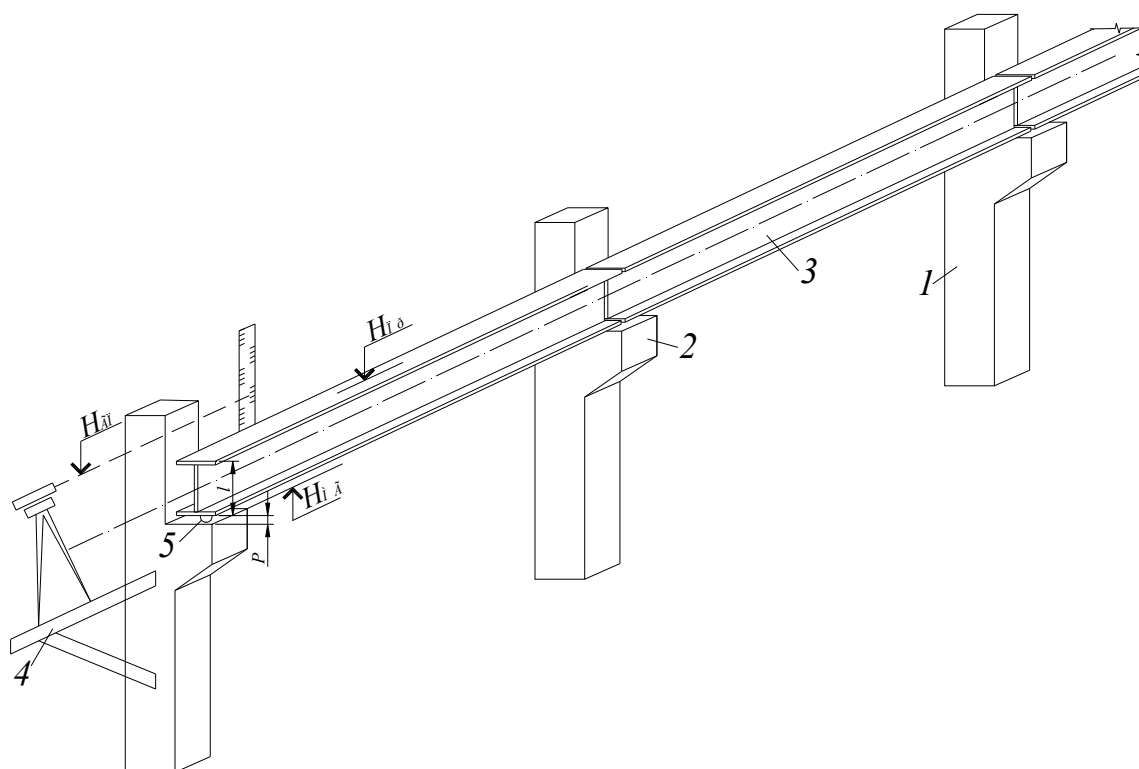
Схема монтажа и выверки по высоте подкрановых балок:
